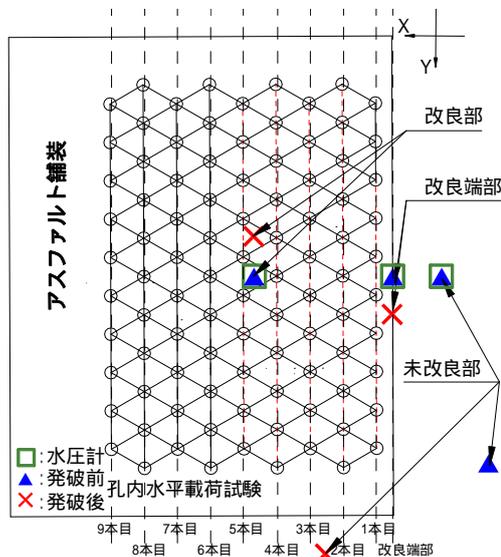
孔内水平載荷試験と間隙水圧計設置平面位置図
